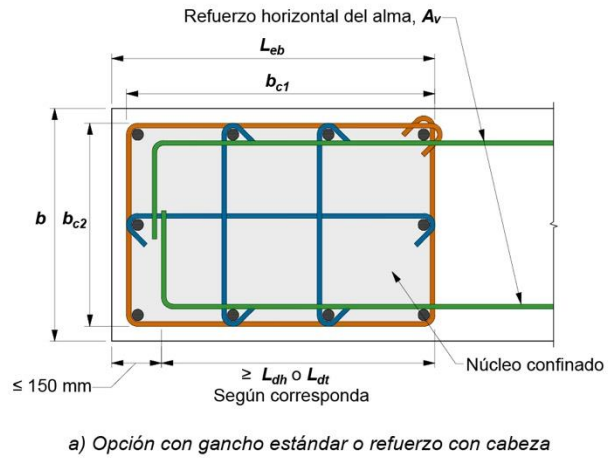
d – Desarrollo del refuerzo horizontal del muro en el elemento de borde con refuerzo transversal de confinamiento en un muro de ductilidad alta (adaptada de ACI CODE-318-19)
